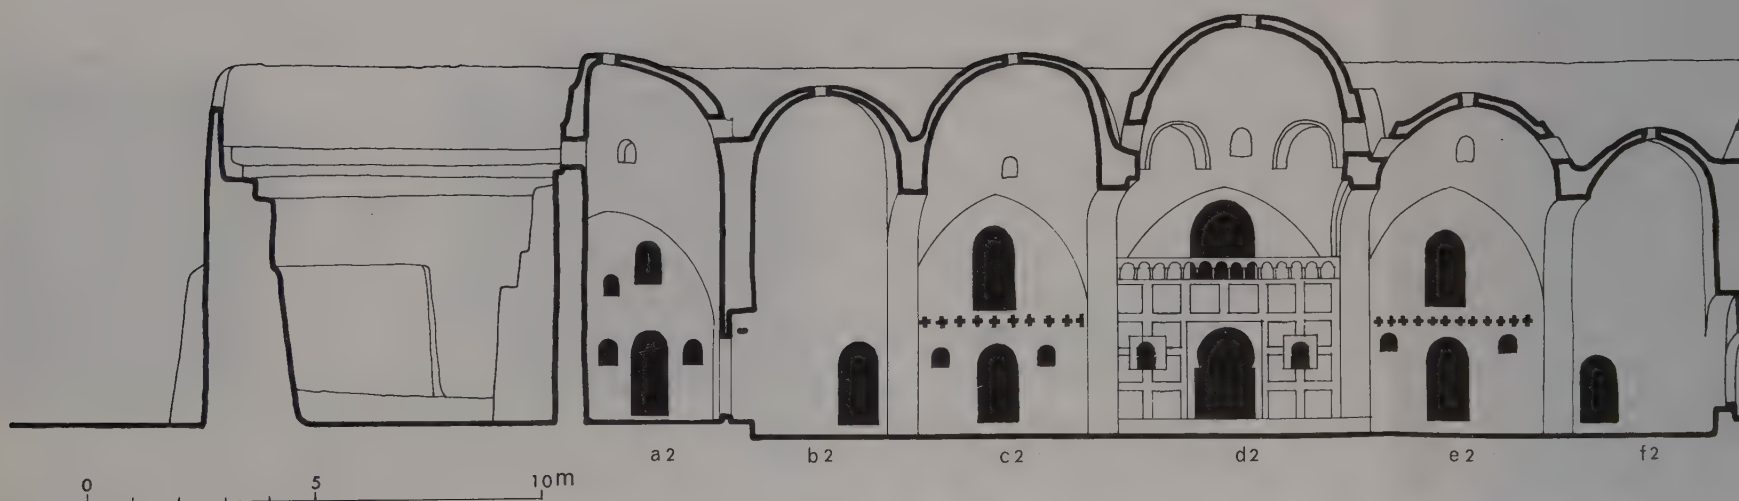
c : Coupe-élévation sur travée (2) montrant la façade des chapelles.
